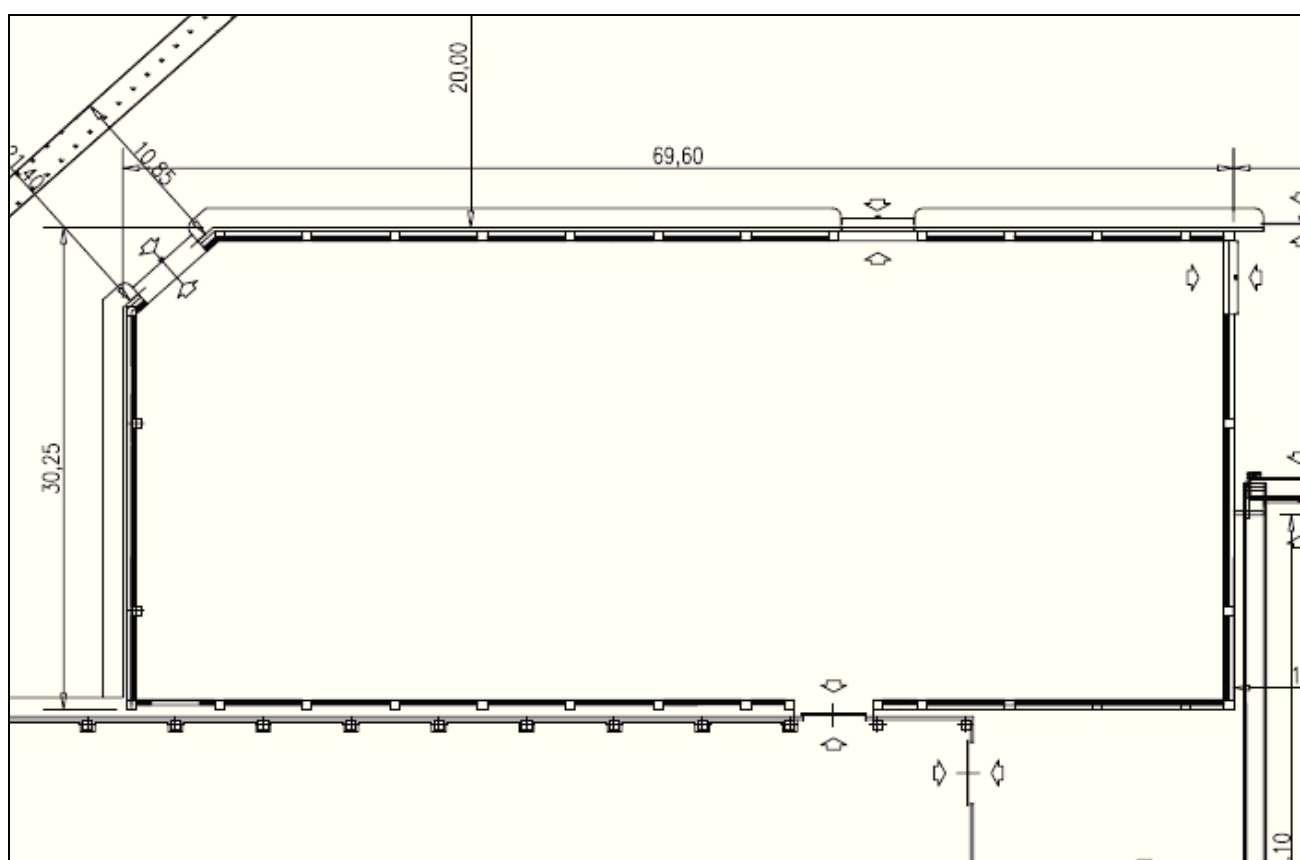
Stralcio planimetrico dell'edificio di seconda maturazione
